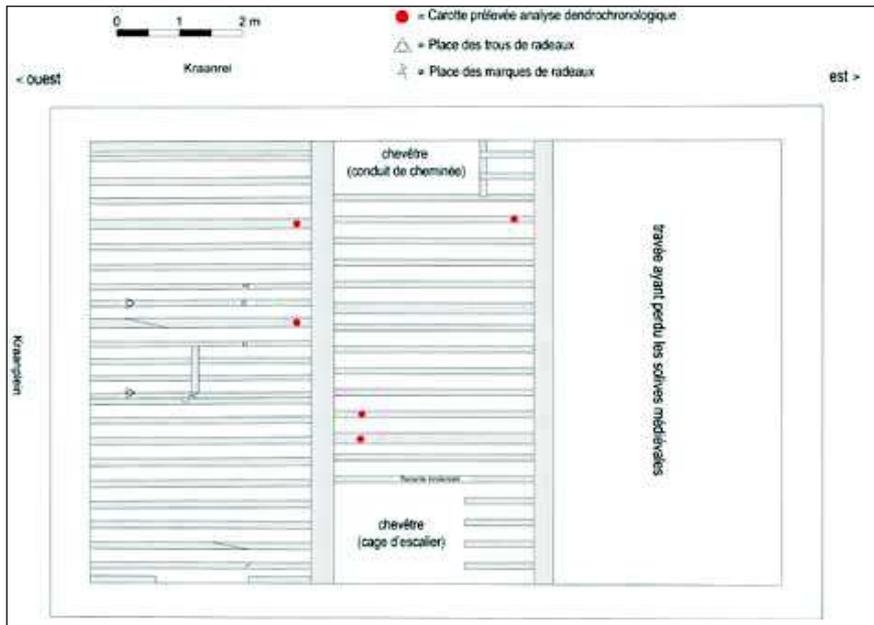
Bruges, 4, Kraanplein, plan du plafond entre le rez-de-chaussée et l'étage (dessin V. Debonne).
